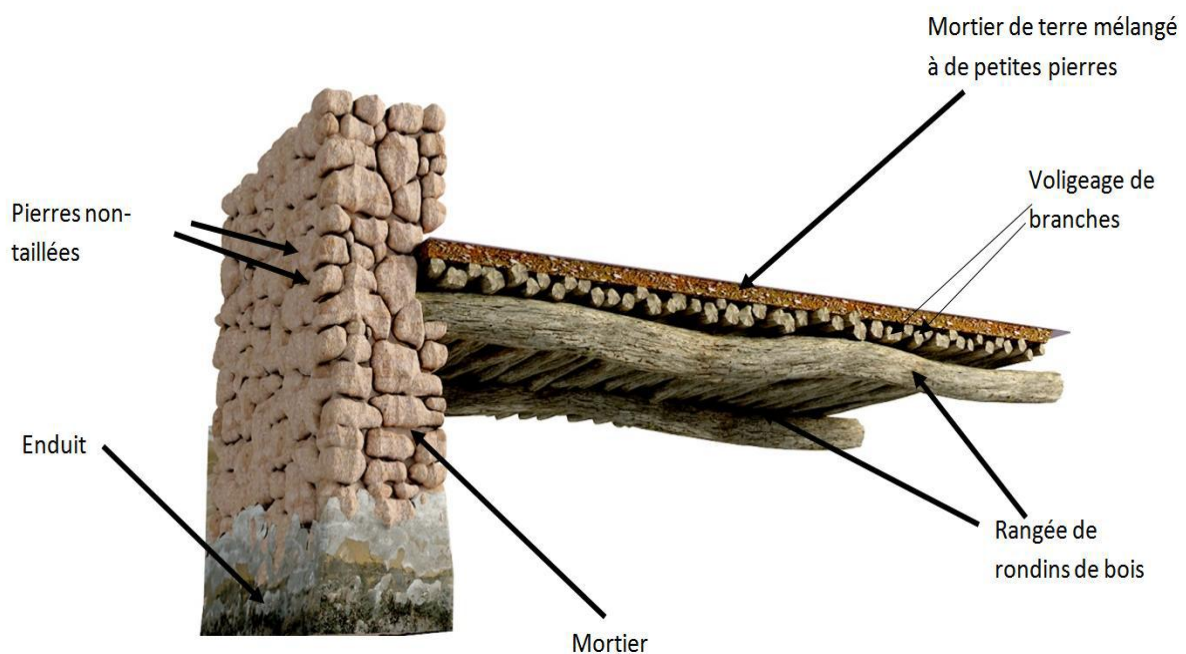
Typologie constructive d'un plancher en rondin de bois
